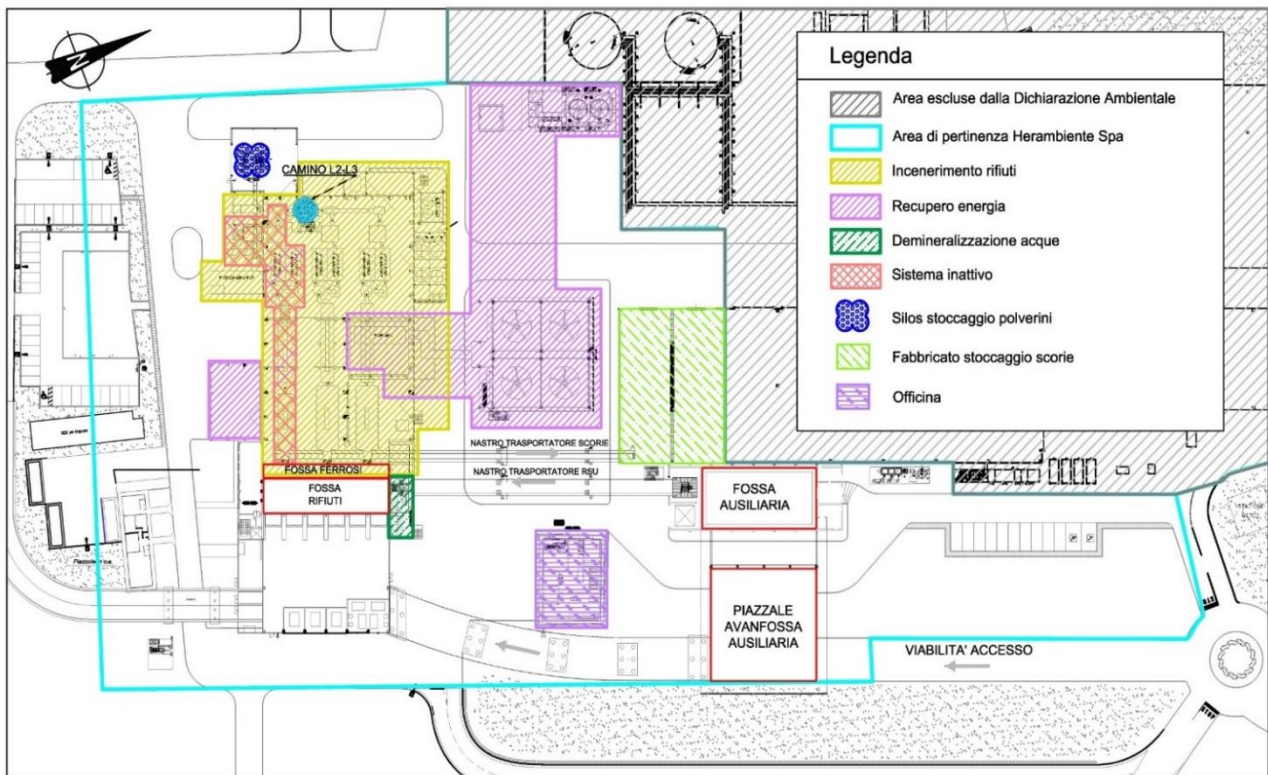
Planimetria di dettaglio dell'impianto di termovalorizzazione
